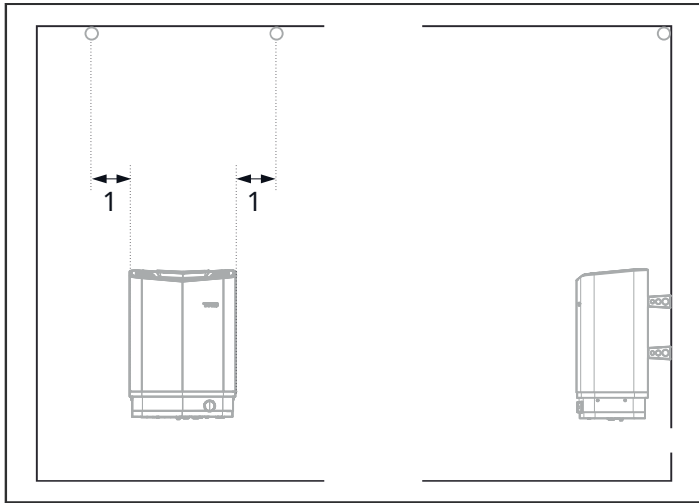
Installazione del sensore sul soffitto sulla linea centrale del riscaldatore visto dalla parte anteriore e laterale
